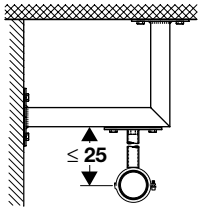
Для больших расстояний от неподвижных опор до стены или потолка мы рекомендуем устанавливать дополнительные опоры
